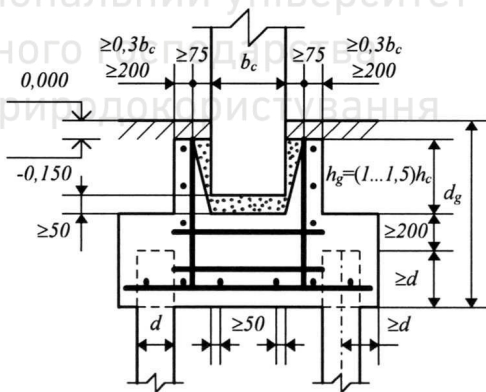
Пальовий фундамент під збірну залізобетонну колону
